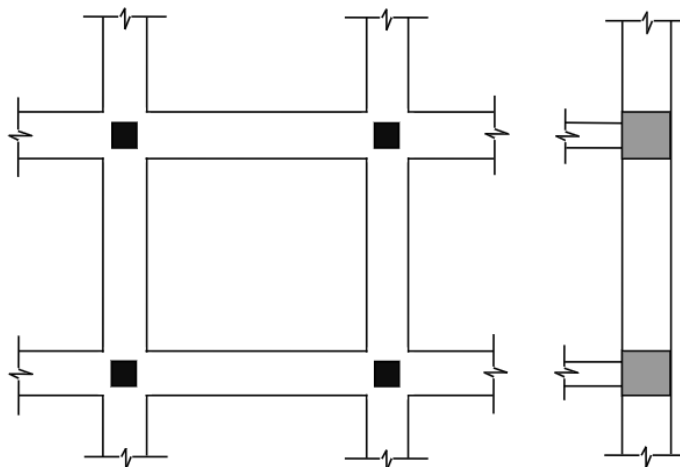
Esquema de uma grelha de fundação (Lopes et al., 2013).
